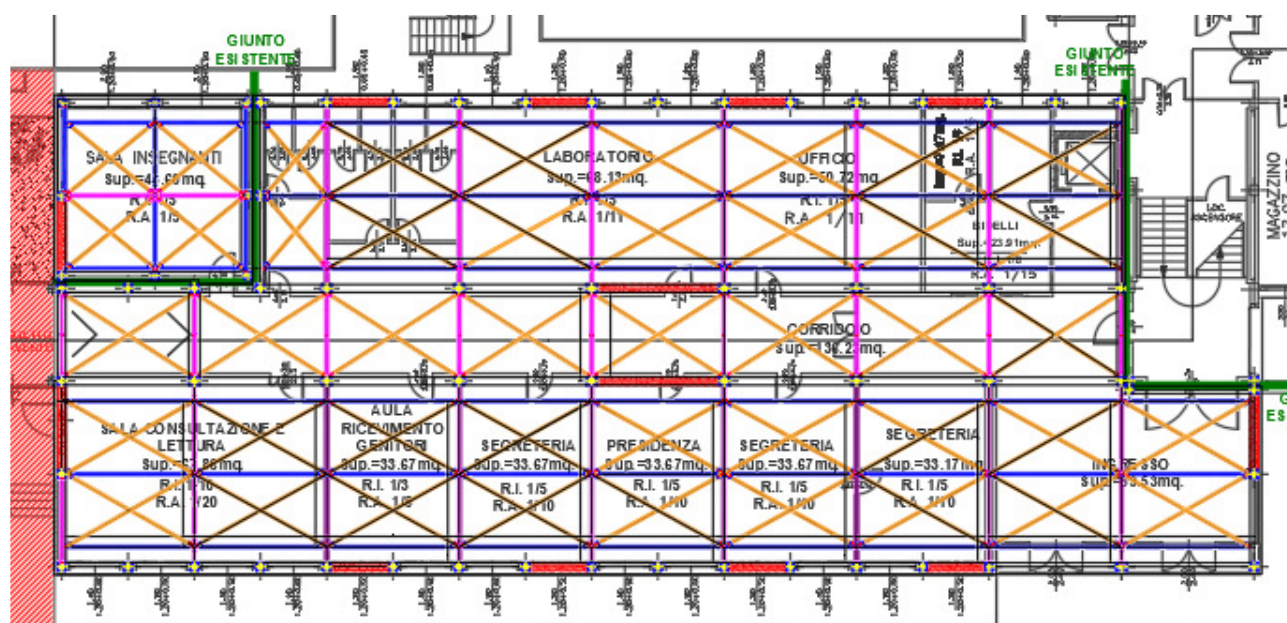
Lavori strutturali LOTTO 2 – piano terra
